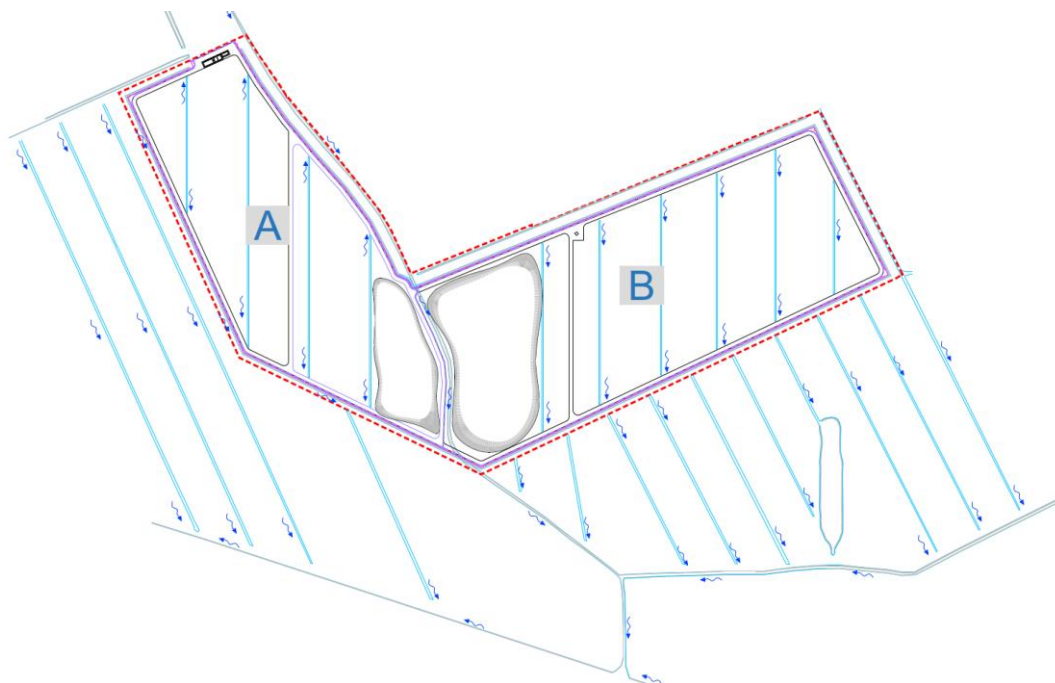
LAY OUT NUOVA DISPOSIZIONE DELLE SCOLINE ORIENTATE CON ASSE NORD/SUD E FOSSO DI GUARDIA PERIMETRALE
